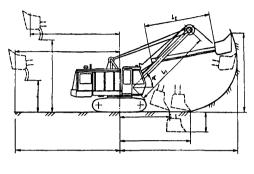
Рабочие размеры одноковшового универсального экскаватора с канатным приводом, оборудованного прямой лопатой
